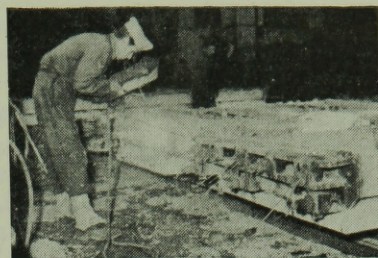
ábra. Födempalló sablon a vibroberendezésben betonozás közben
